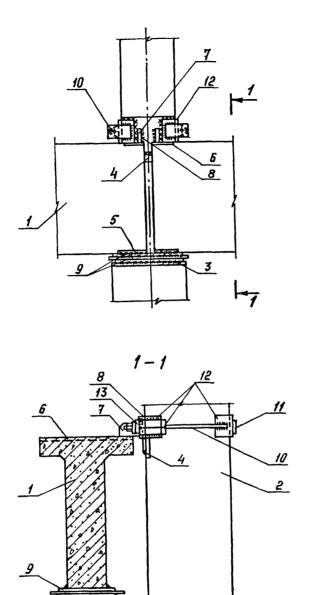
Усиление крепления подкрановой балки к колонне
